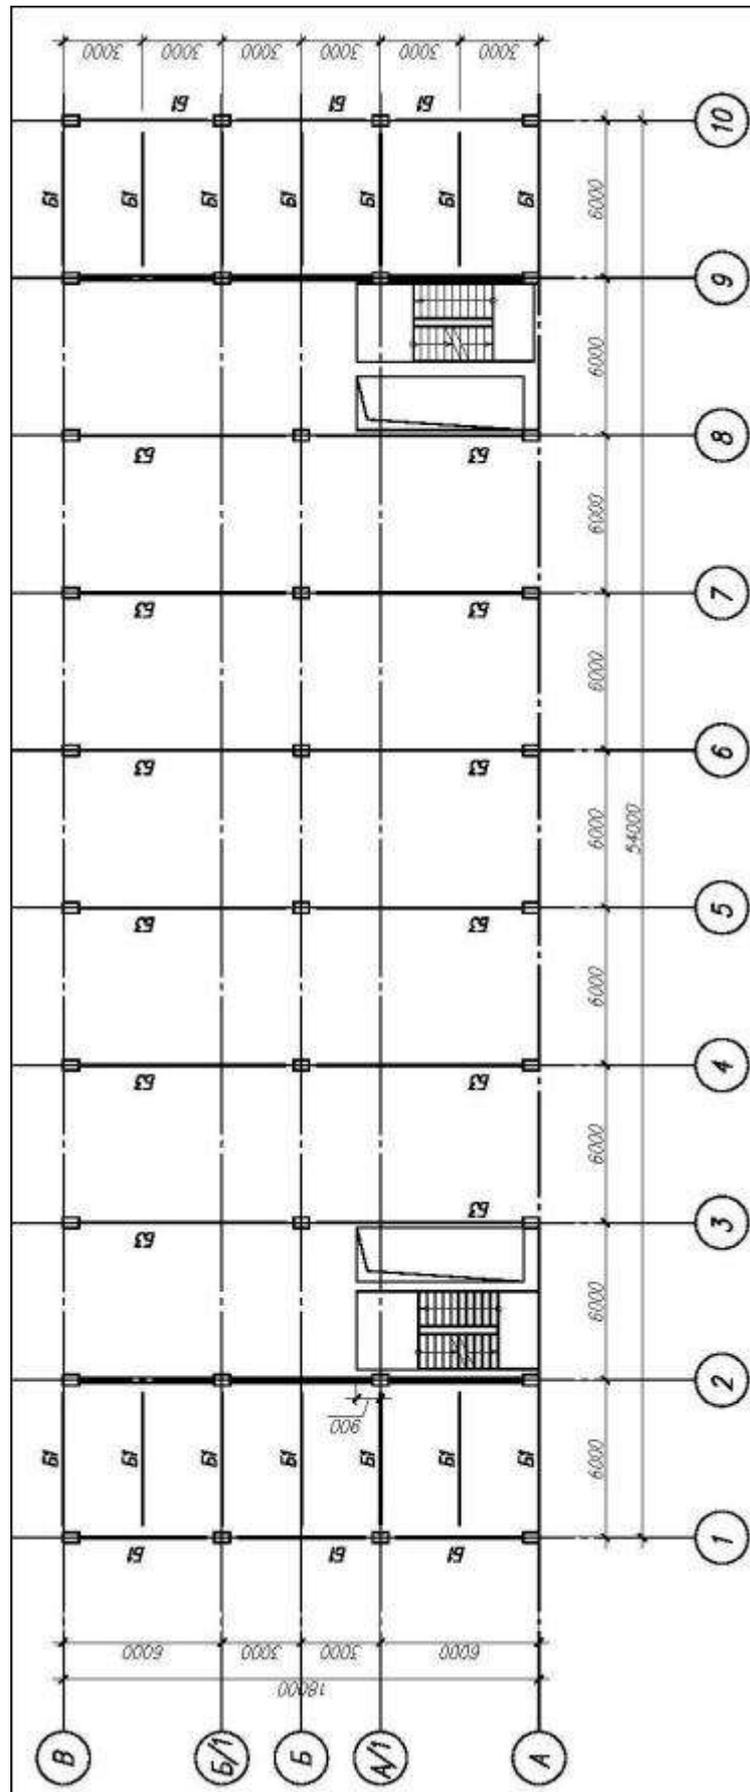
План типового поверху промислової будівлі до реконструкції
